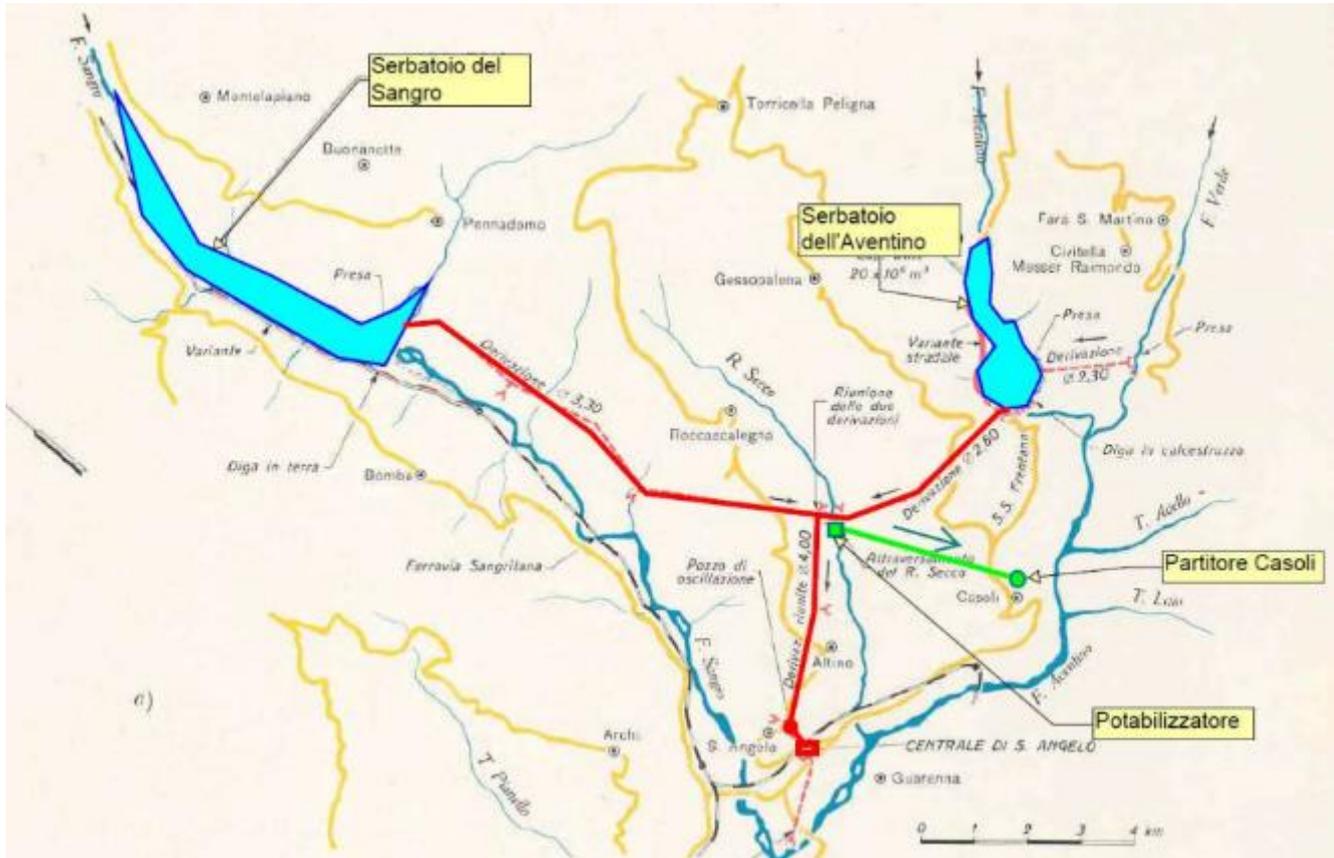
schema planimetrico delle derivazioni dai laghi di Casoli e di Bomba
